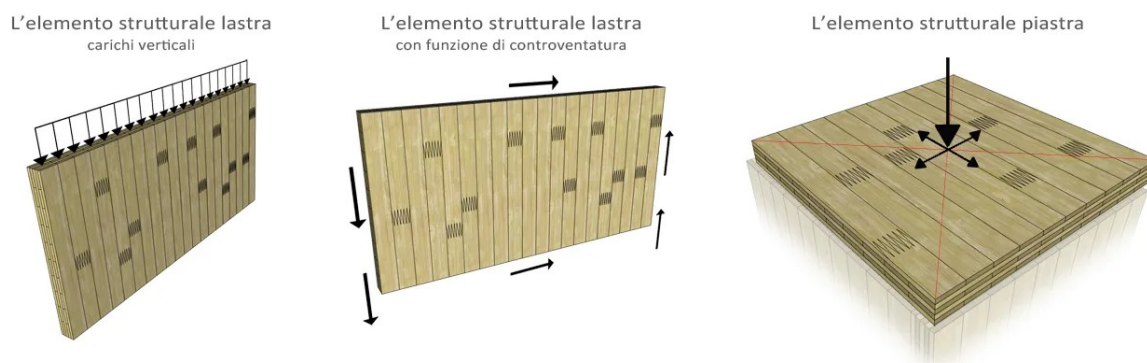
(a) Elemento di parete con funzione di lastra, (b) Elemento di parete con funzione di controvento, (c) Elemento piastra
